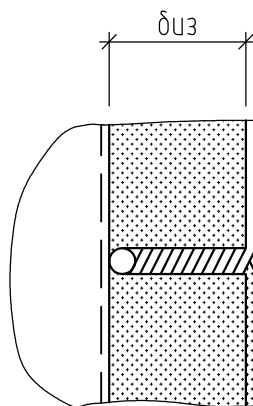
Изоляция трубопровода матами ТМ БАТИЗ в один слой с креплением проволочными стяжками и бандажами.
